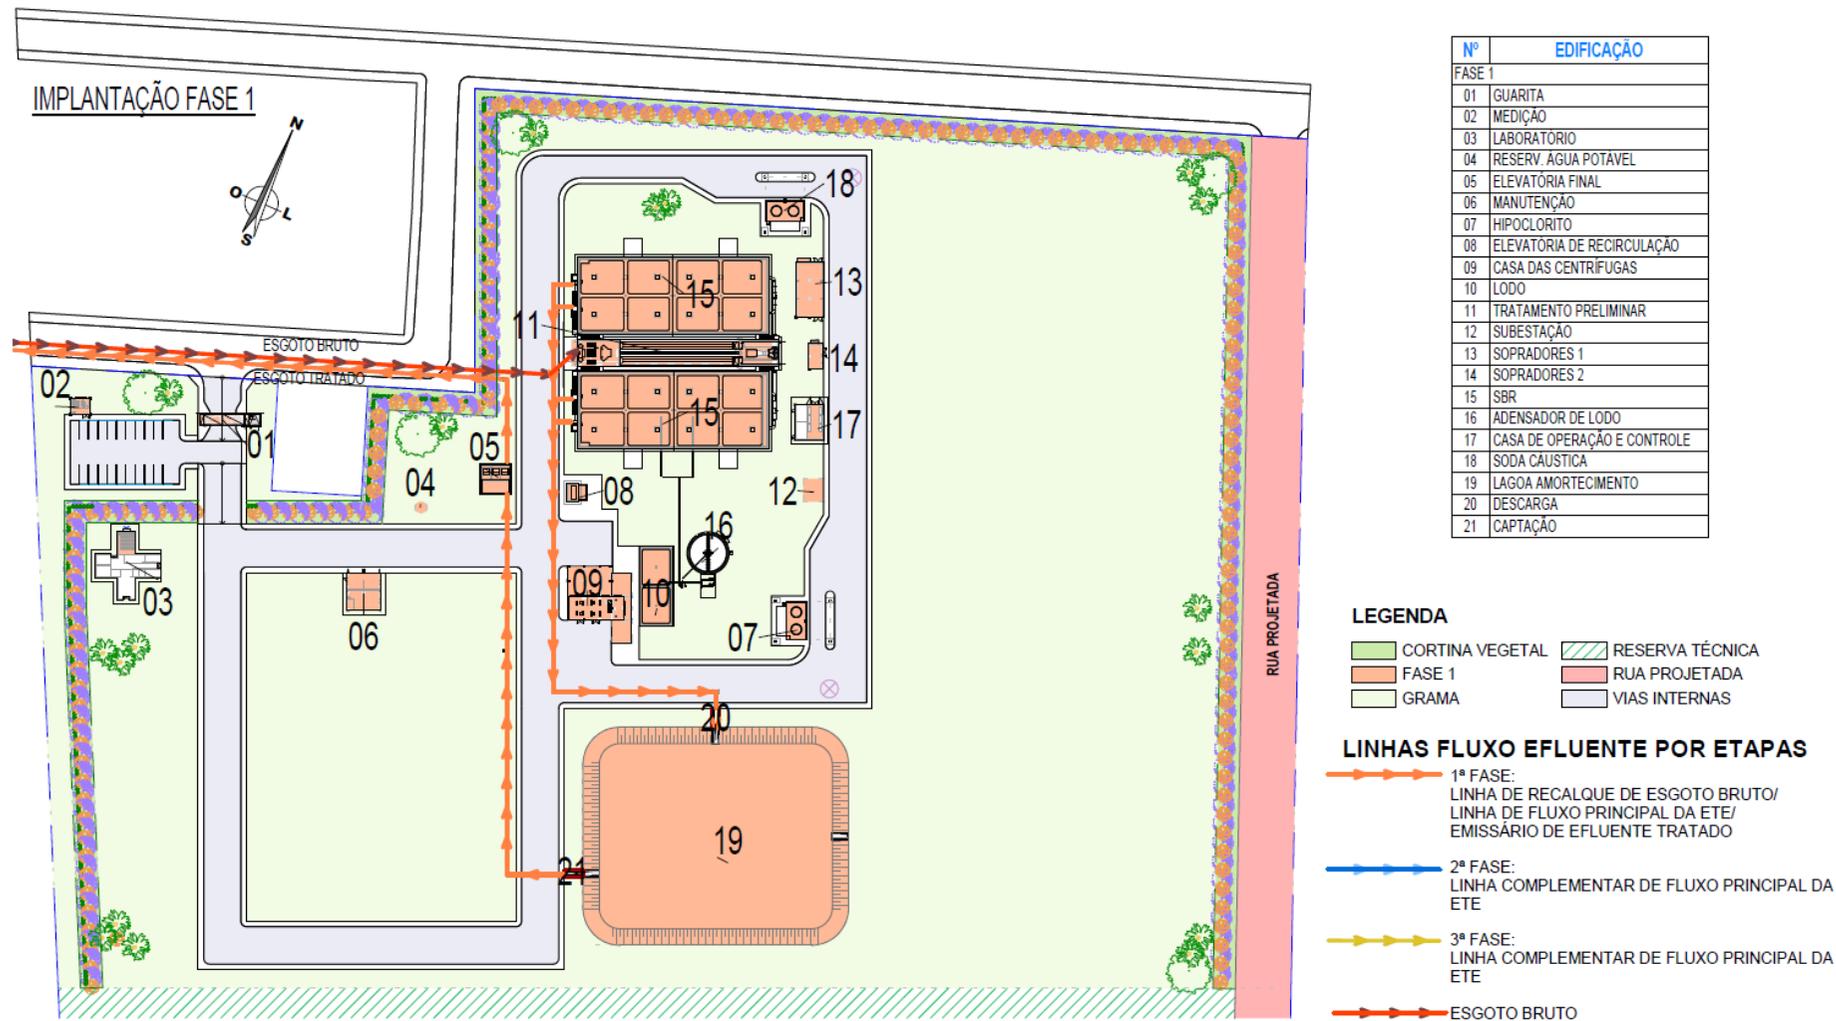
Implantação geral da ETE Luiz Rau (fase 1)
